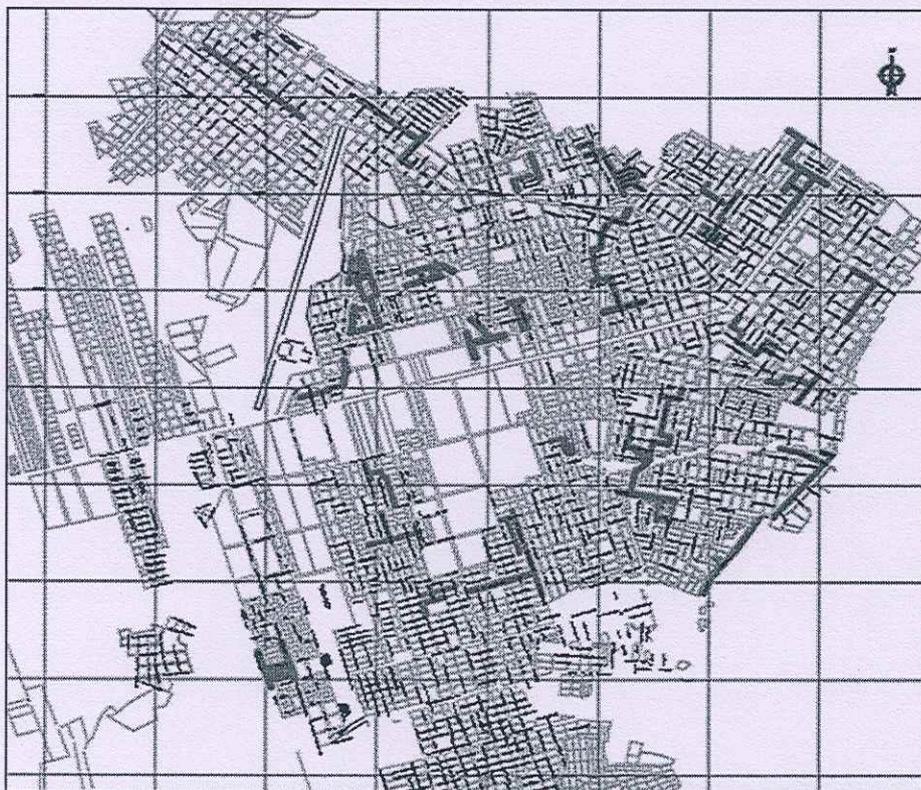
Ubicación para la limpieza de la red de alcantarillado
